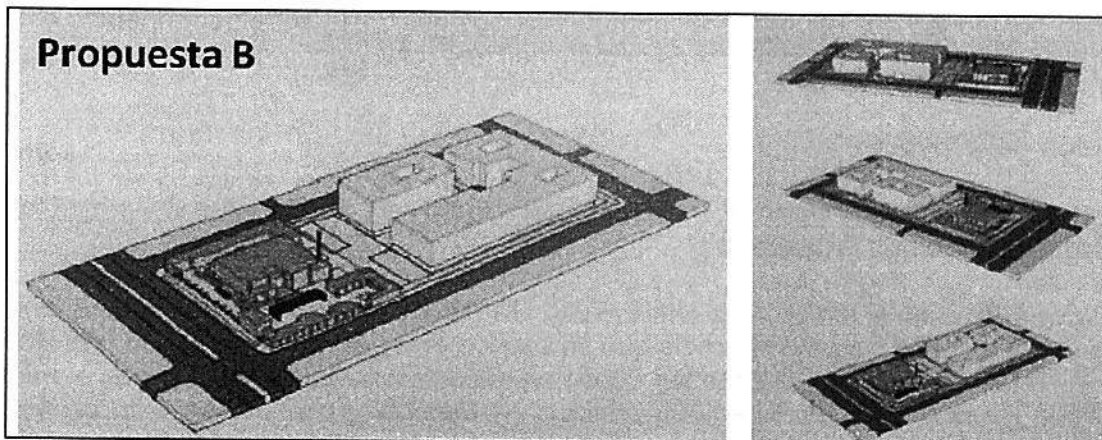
Vistas generales de la propuesta B, fuente: Consorcio Diseñar, DSB Arquitectos, 2017.
